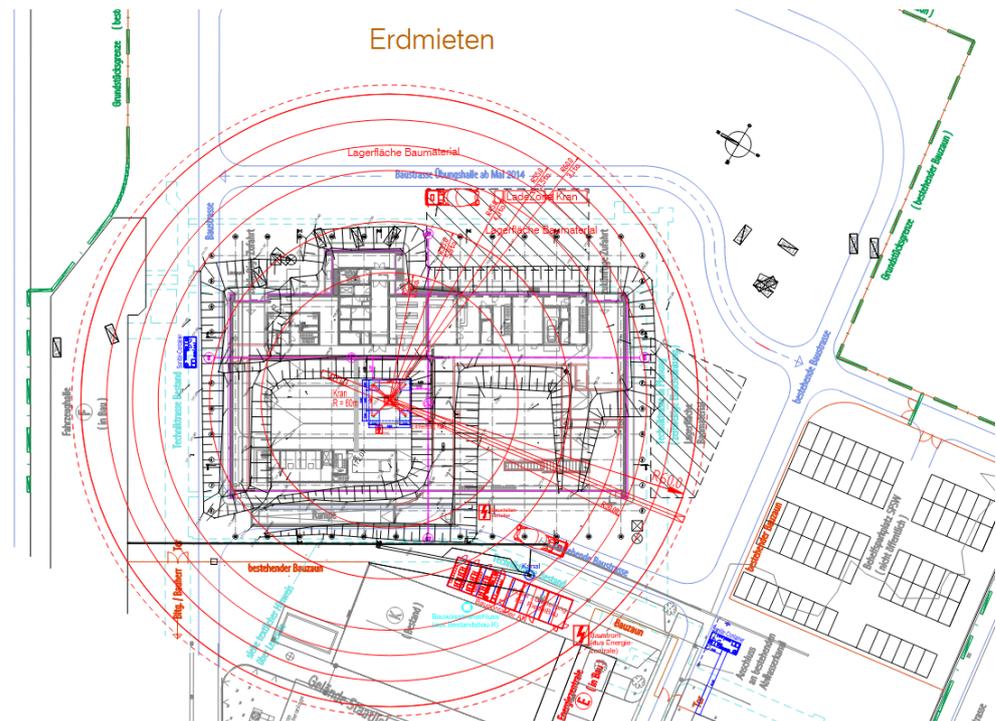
Beispiel eines auftragnehmerseitig hergestellten BE-Planes mit Kranradien, Baugruben-Böschungen, den Zufahrtsmöglichkeiten vom öffentlichen Straßenraum aus sowie daran anschließende, baufeldinterne Baustraßen
